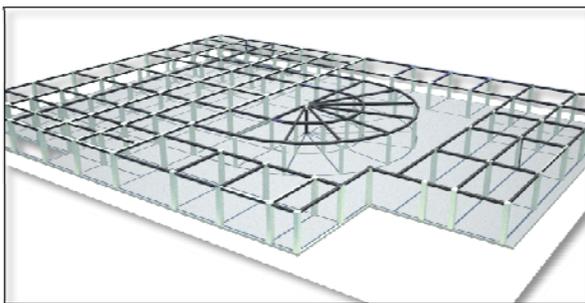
Uso de elementos estructurales de acero como en vigas, columnas, losas de entrepiso, y la ortogonalidad.
